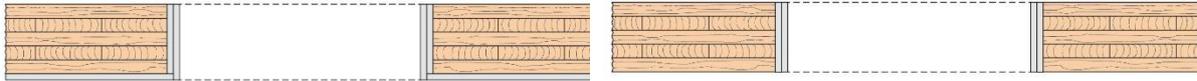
Ausführung einer Massivholzdecke mit Kapselung
